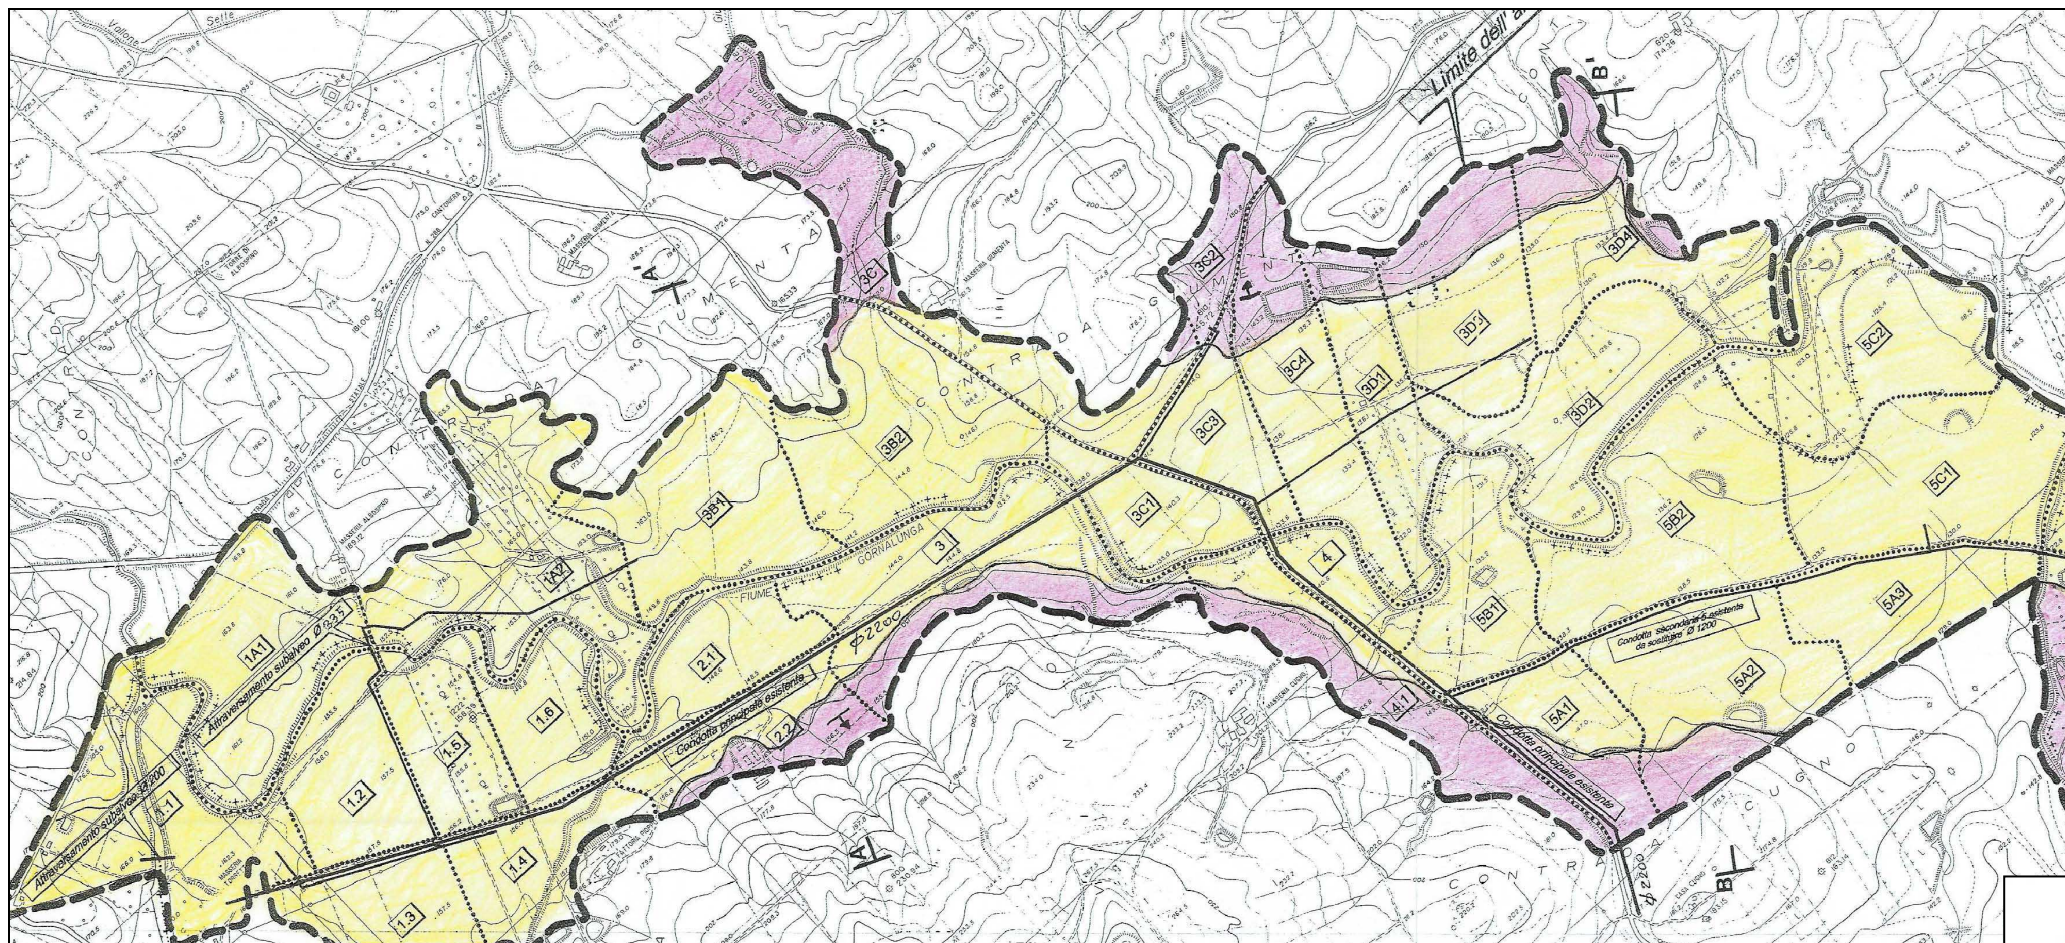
Planimetria intervento realizzato nel tratto di monte con individuazione degli orizzonti litostratigrafici.
